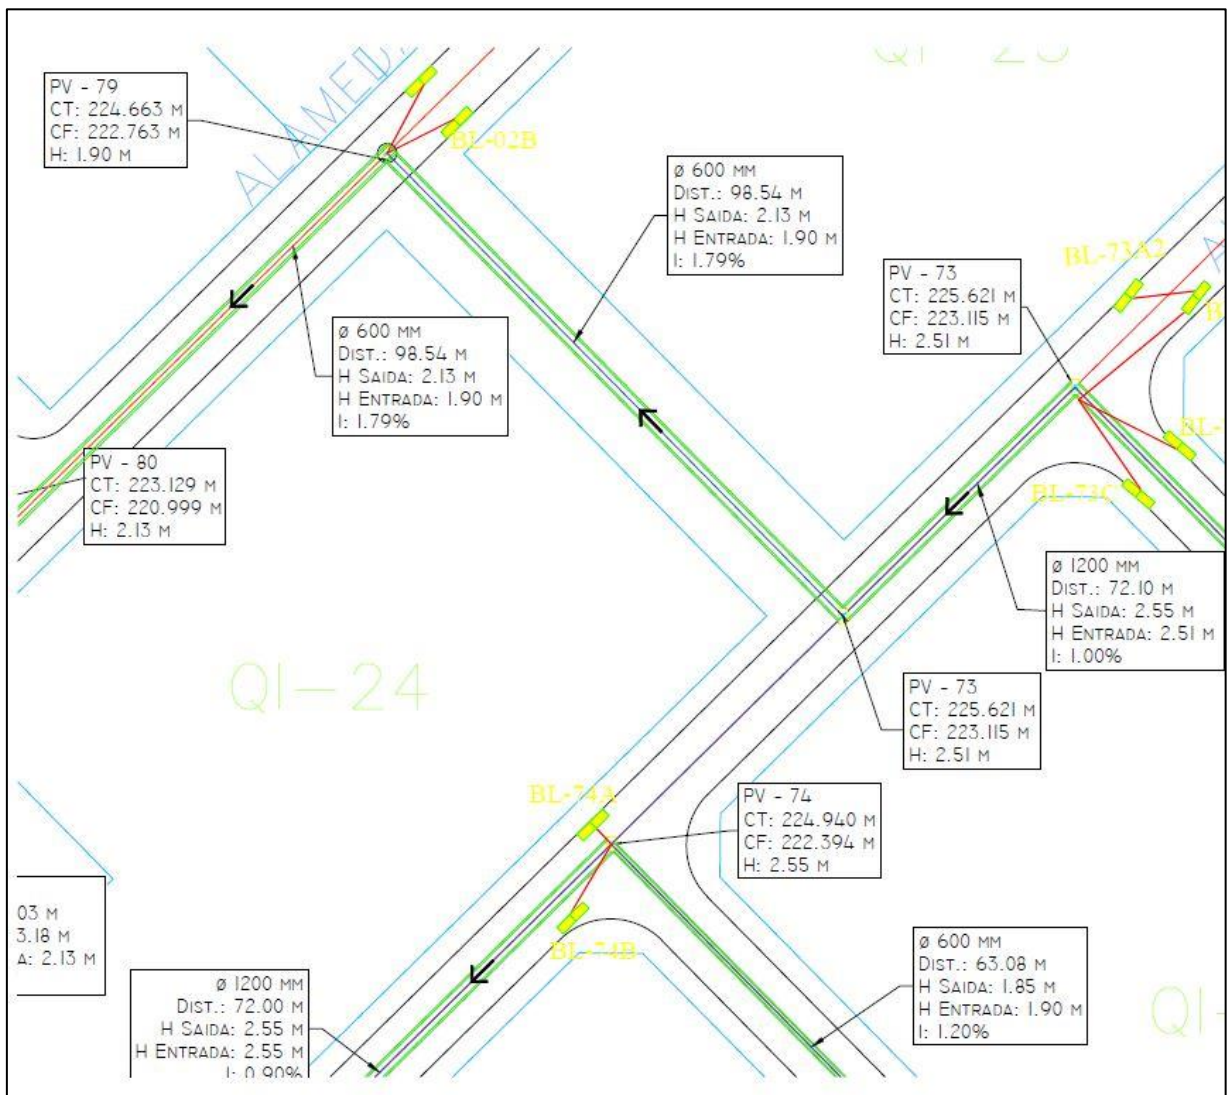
Projeto Básico de Drenagem Alterado Lote-01
